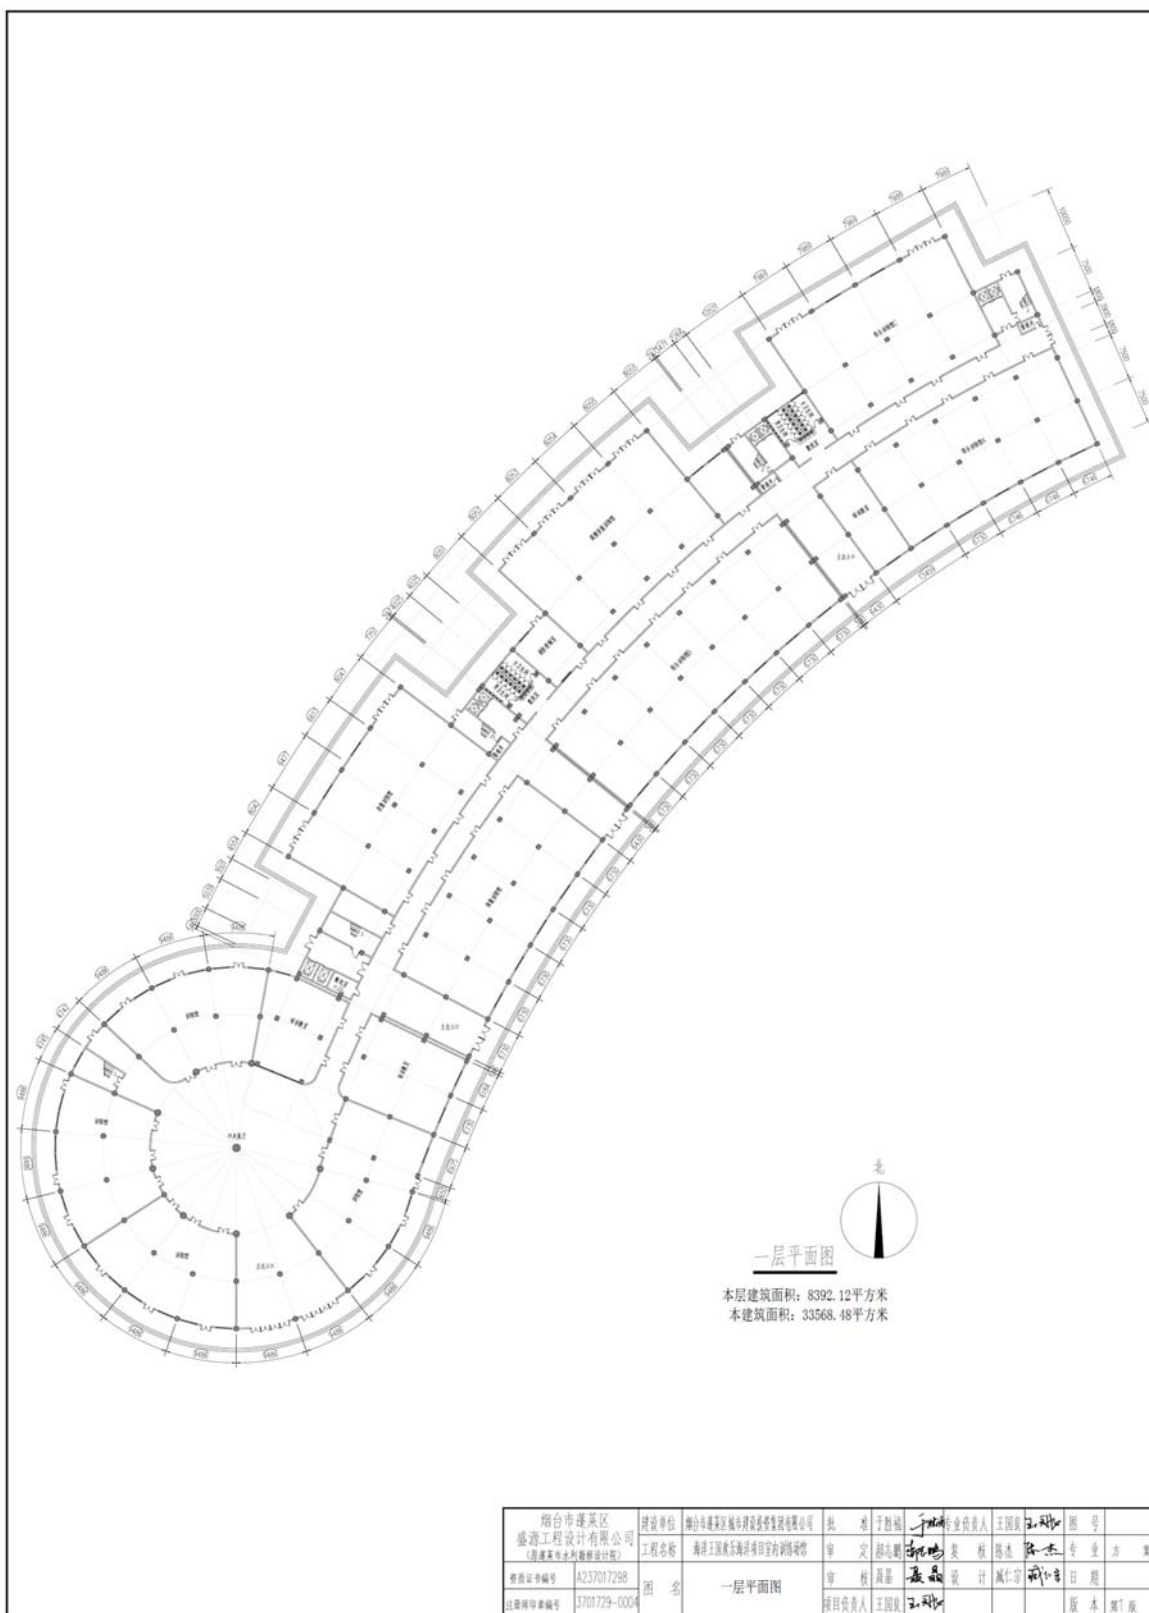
室内训练场馆平面布置图（一层）
